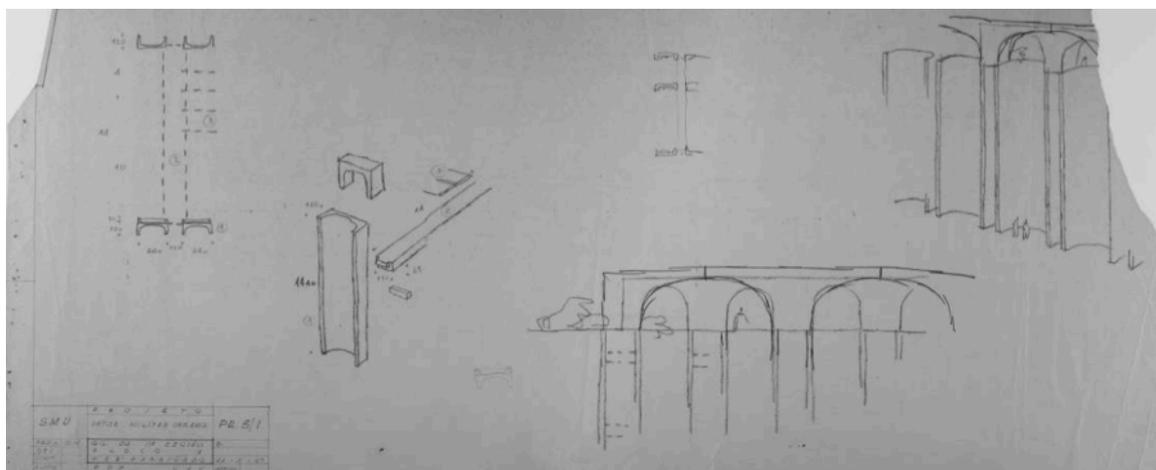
Esquema do Sistema Construtivo. Fonte: Fundação Oscar Niemeyer
